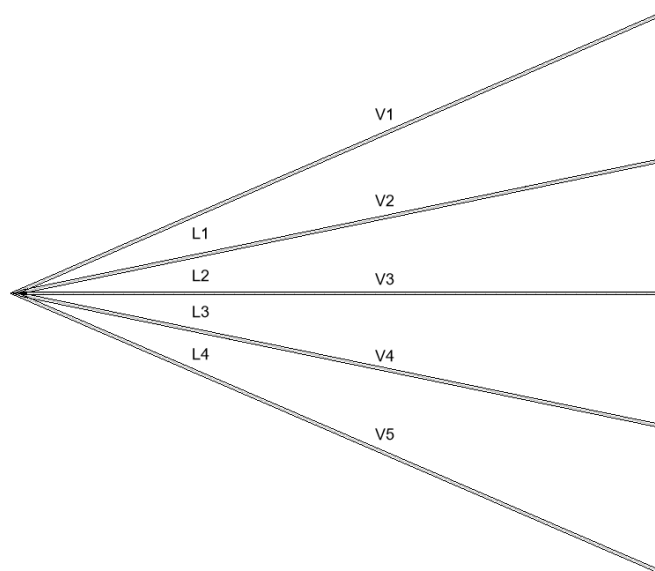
Nomenclatura dos elementos estruturais da cobertura. Fonte: Autor
